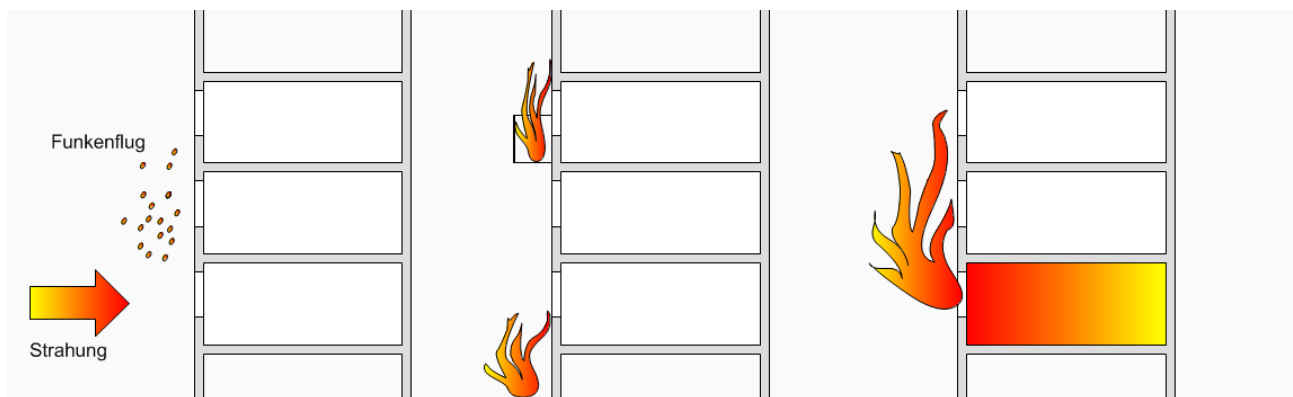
Brandszenarien a) Brand eines benachbarten Gebäudes b) Brand außerhalb des Gebäudes c) Brand innerhalb eines Gebäudes; Fire scenarios a) Fire of a neighboring building b) Fire outside the building c) Fire inside a building
